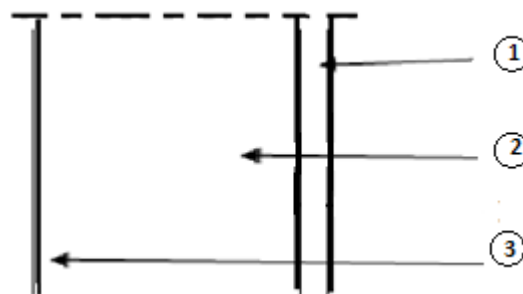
Coupe transversale des murs intérieurs type 01.
